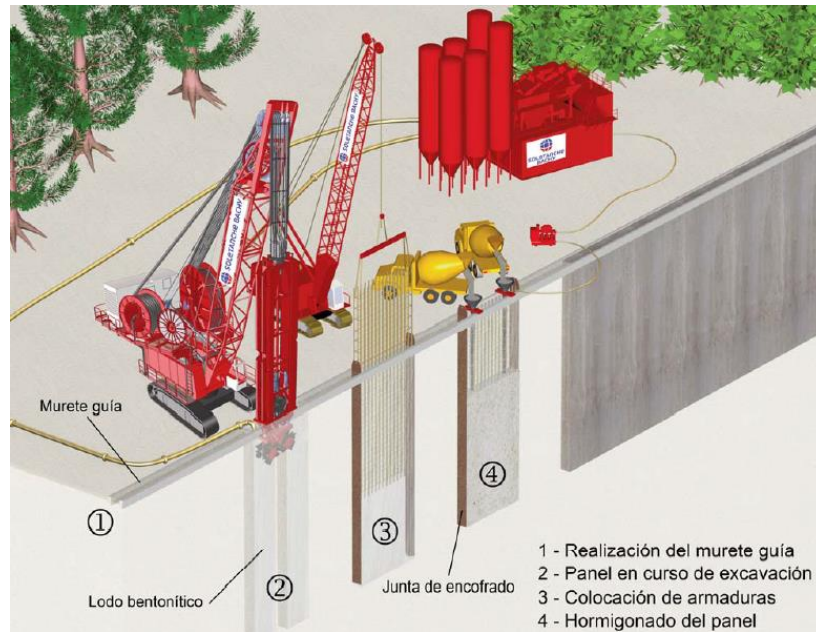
Procedimiento de construcción del Muro Milán.¹⁹
